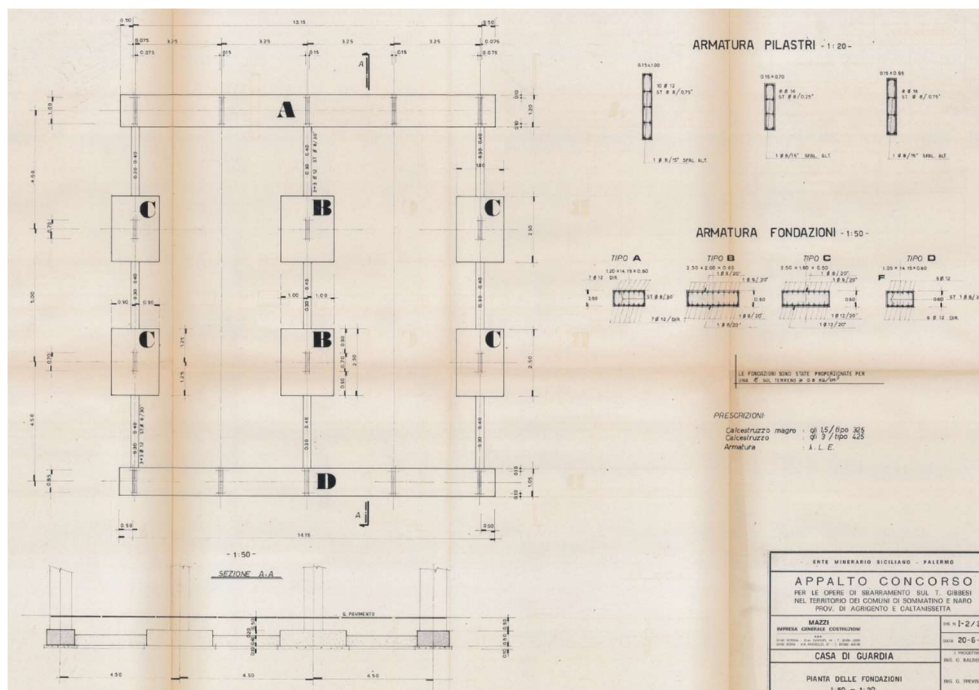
Progetto di fattibilità del 1972 – Pianta delle fondazioni
